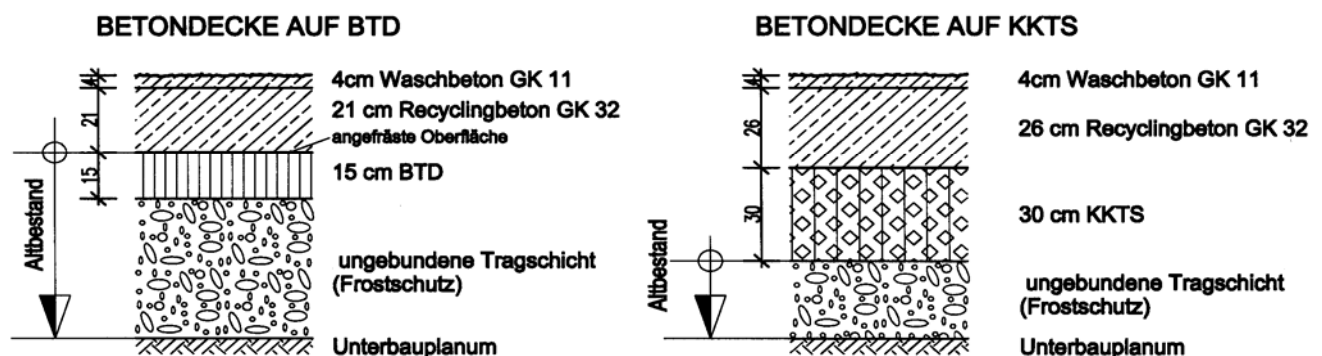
Schematische Darstellung Betondecke auf bit. TS und KKTS
